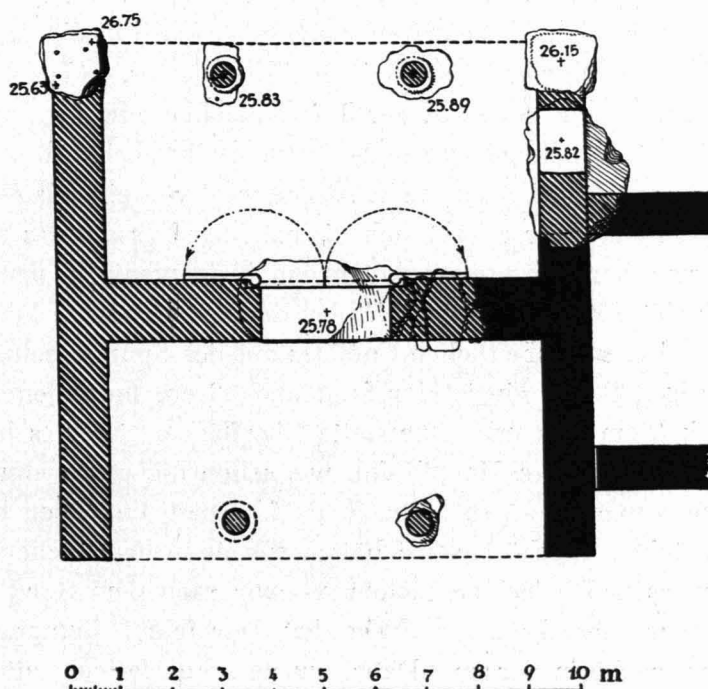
Das kleine Propylon. Ergänzter Plan.
